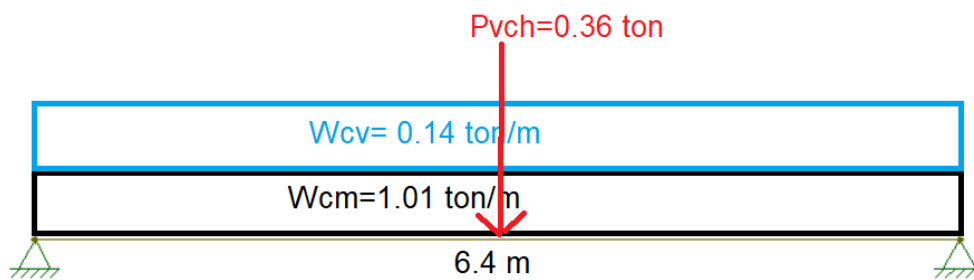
Esquema de cargas en servicio sobre viga VP-13
